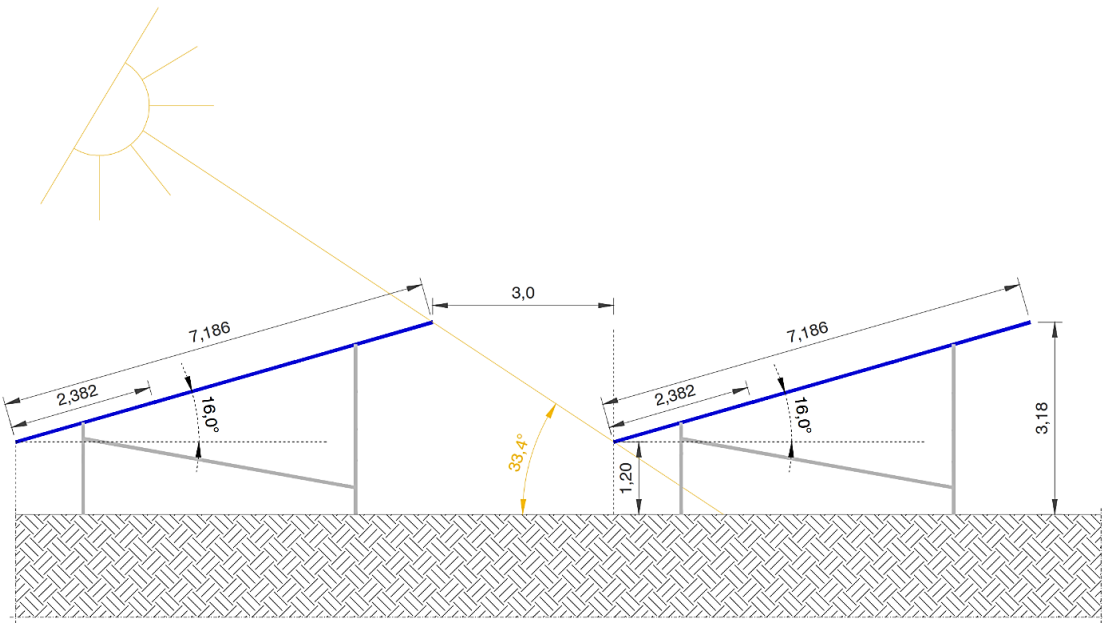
Plan en coupe des tables (source : H2AIR, 2025)
